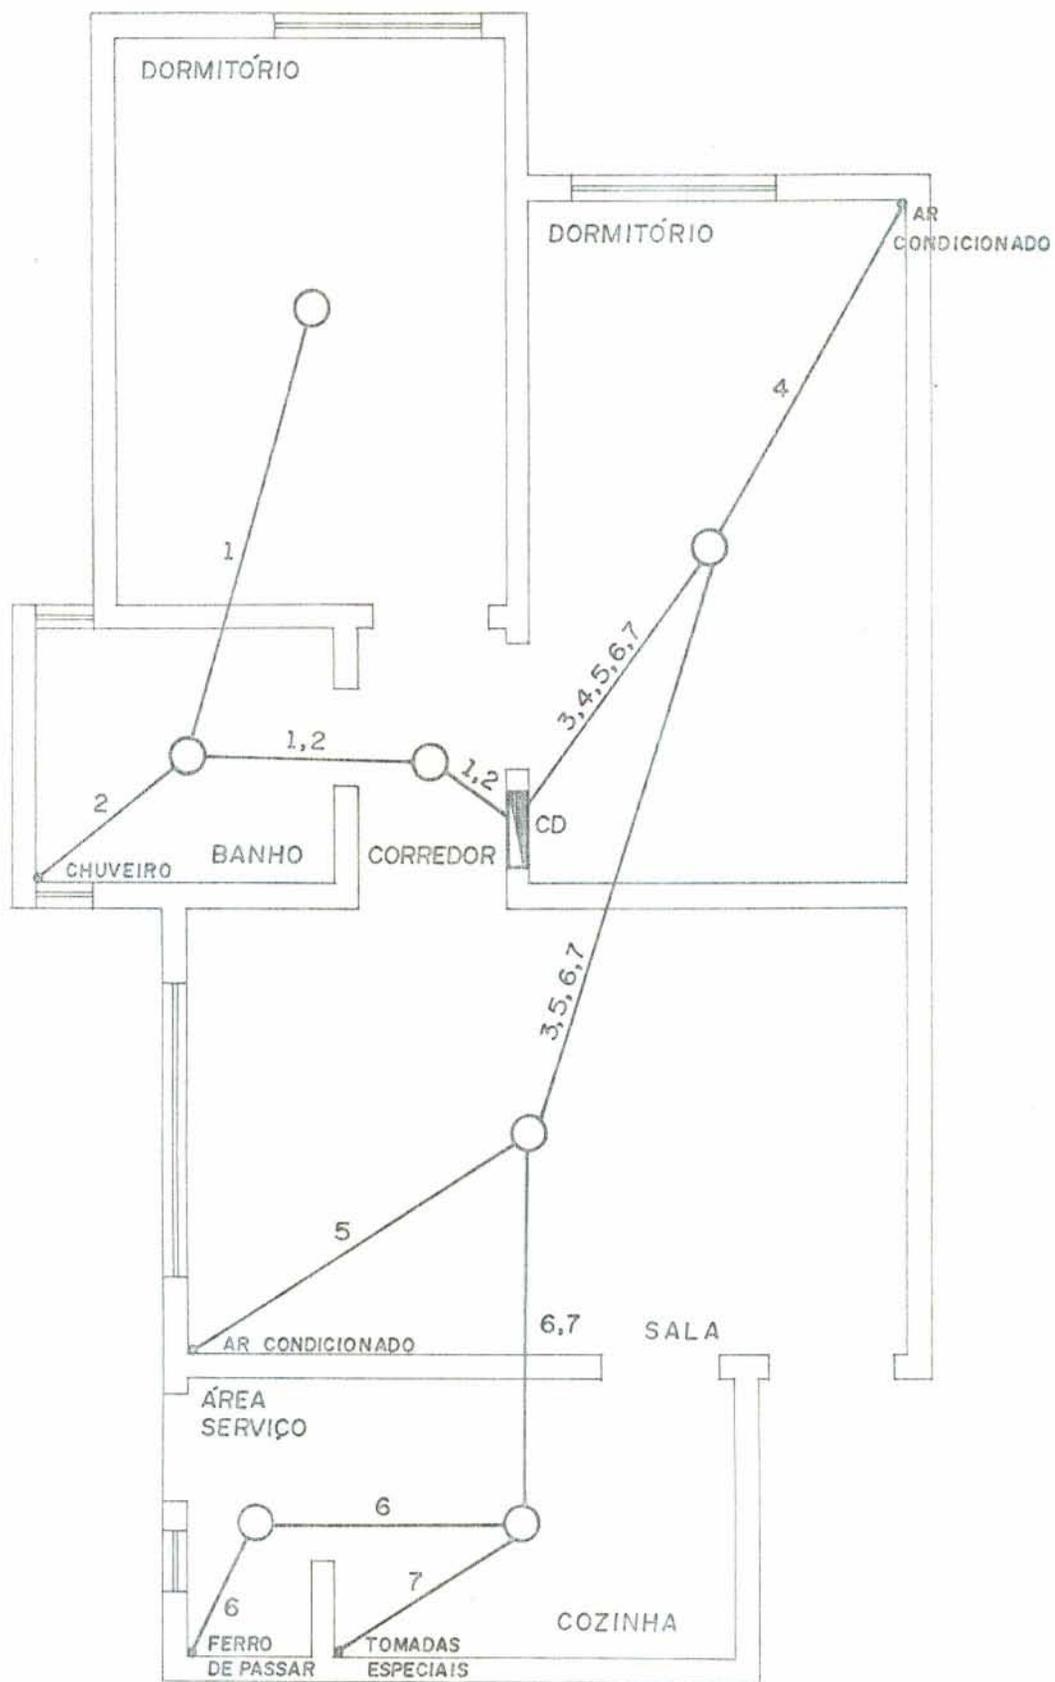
PLANTA DO APARTAMENTO DO PAVIMENTO TÉRREO
